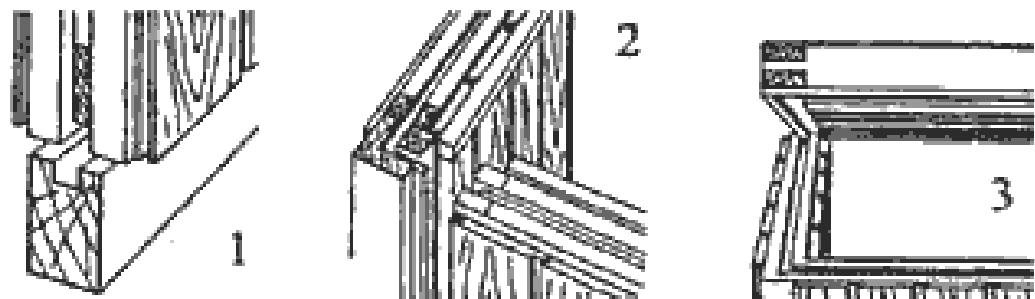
Соединения щитовых стеновых элементов сауны: 1 — рамка под стойку; 2 — угловое соединение стен; 3 — стык стены с потолком.
